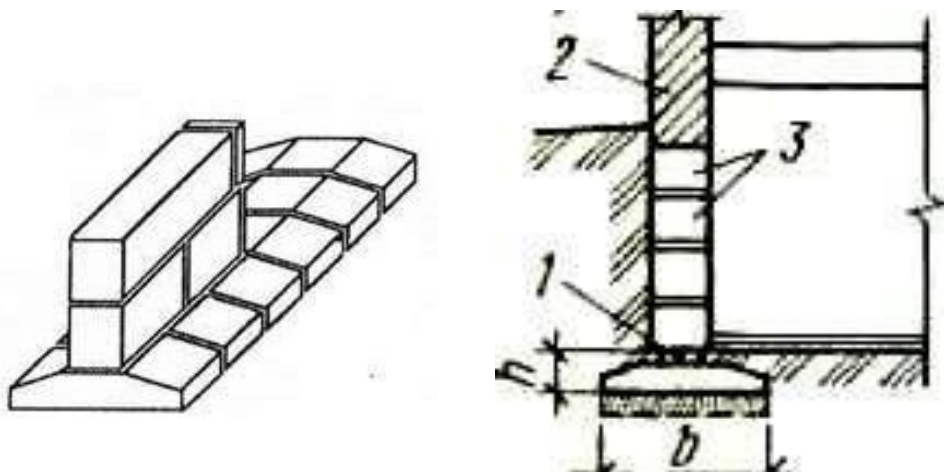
Сборный железобетонный фундамент ленточного типа
